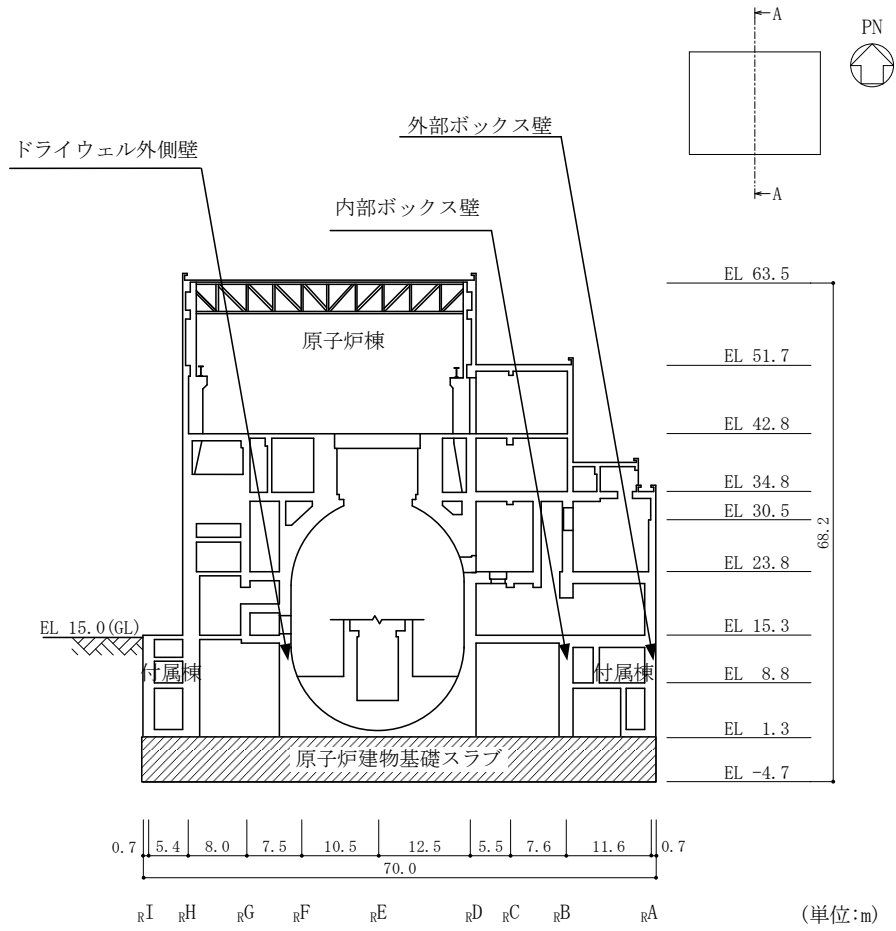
(1) 原子炉建物基礎スラブの概略断面図 (A-A断面, NS方向)
